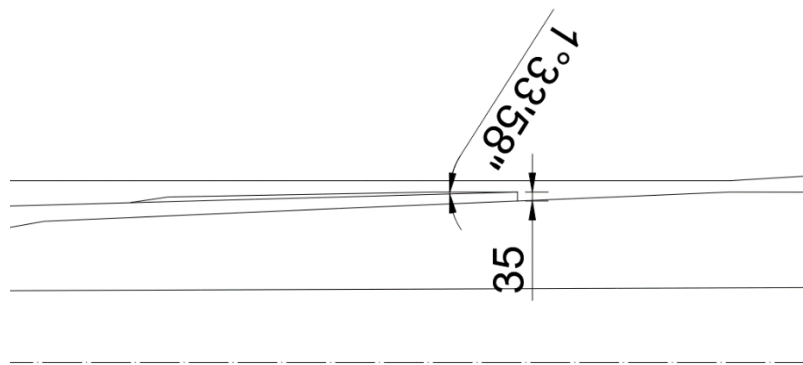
Схема частини стрілочного перевалу із тупою хрестовиною, марки 1/11, тип рейки Р65
